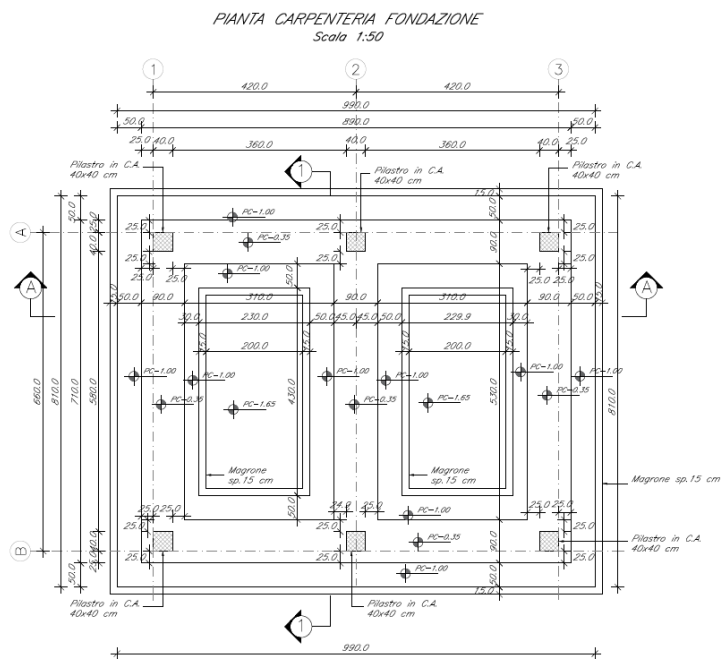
Pianta Fondazioni – Locale consegna
